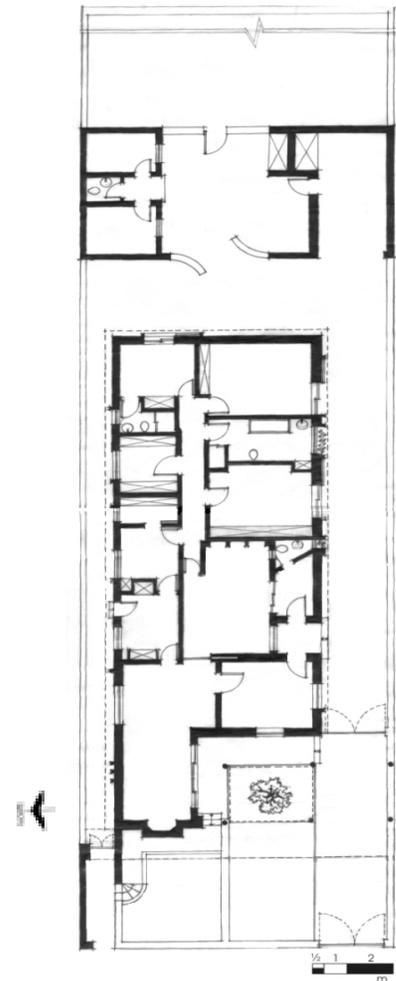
Casa José Carlos Costa. Planta baixa.
